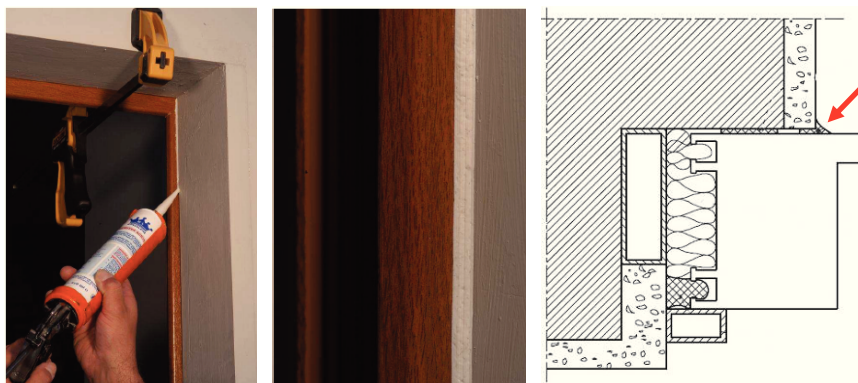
esempio di corretta applicazione del sigillante sul perimetro esterno del giunto tra telaio fisso e muratura [49]
